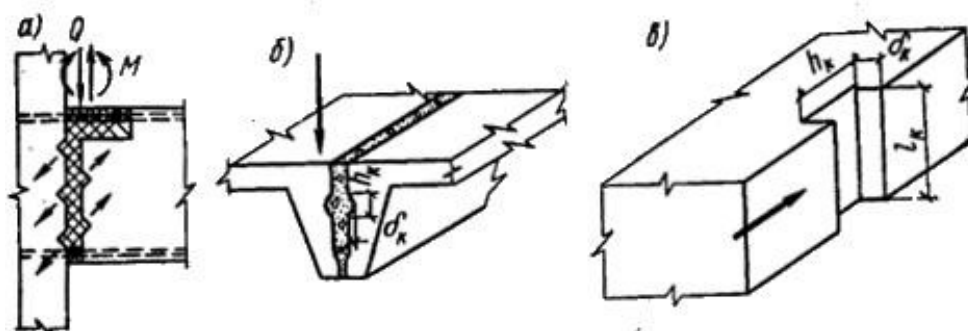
Бетонные шпонки в стыках и соединениях элементов
